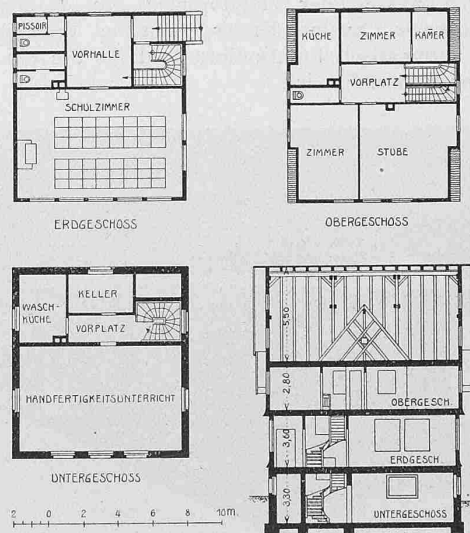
Schulhaus Gätzberg. Grundrisse und Schnitt 1 : 400.
